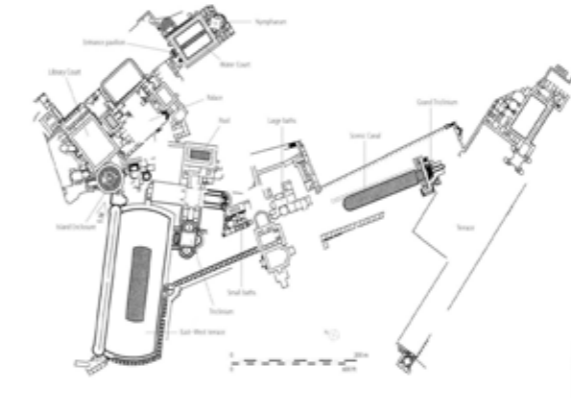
Planta de la Villa Adriana, Tivoli, Roma.
